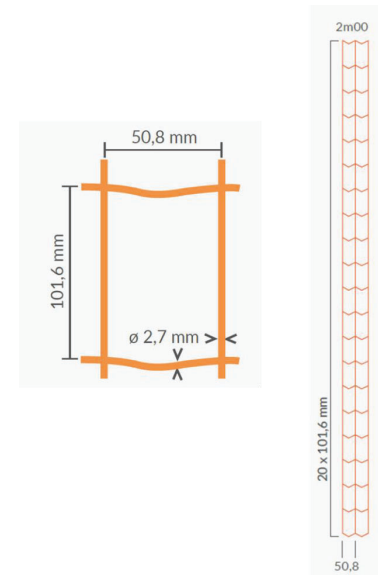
Dimensions du grillage considéré pour clôturer le site
